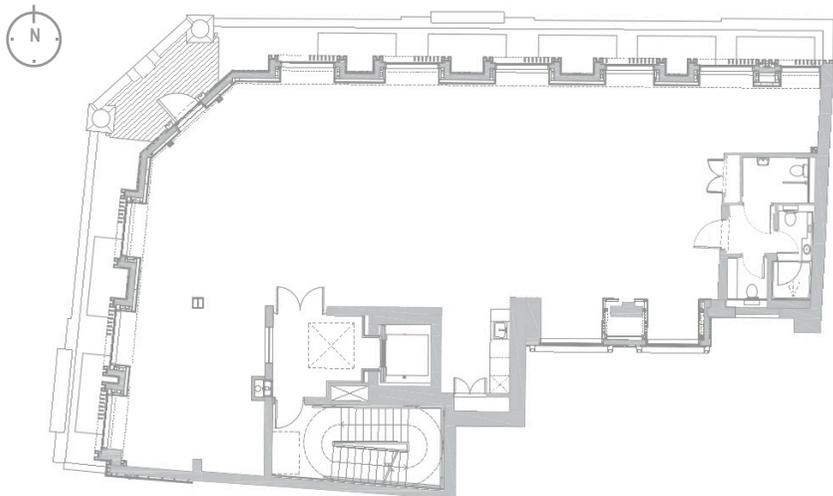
Axtell Soho*, pianta 5° piano.
